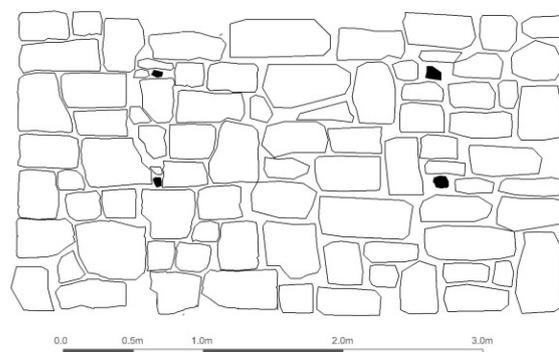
Detalle de la tapia de mampostería de la iglesia de Santa María la Mayor. Fuentepelayo. SG.
